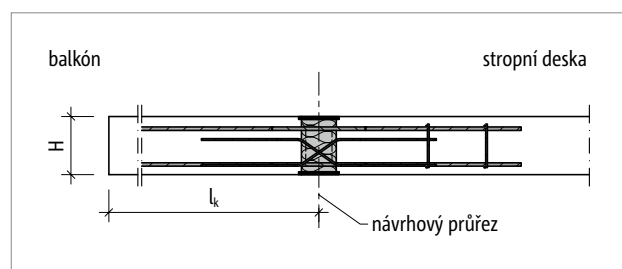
Schöck Isokorb® XT typ DP: Statický systém
